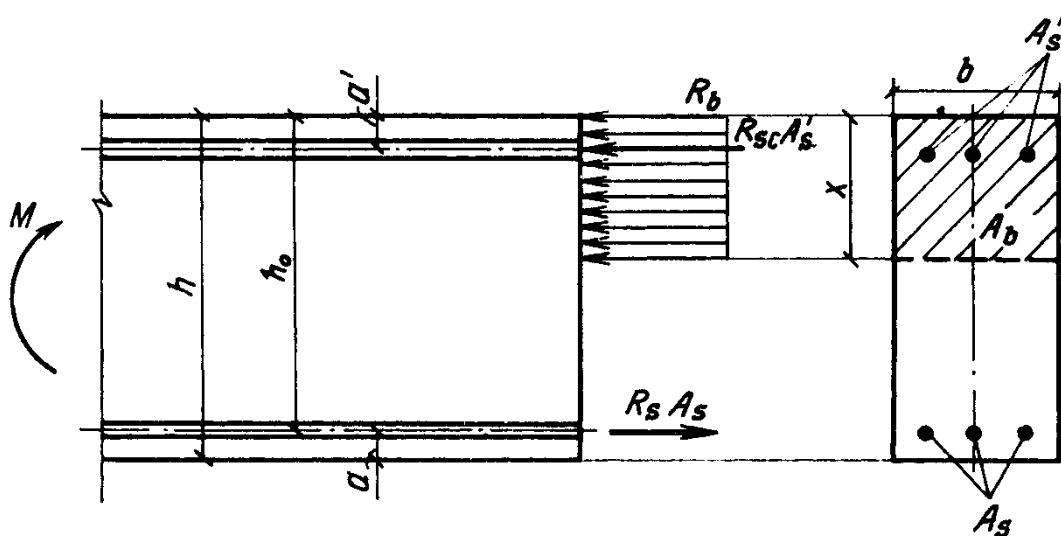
Схема зусиль в нормальному перерізі елемента, що згинається
